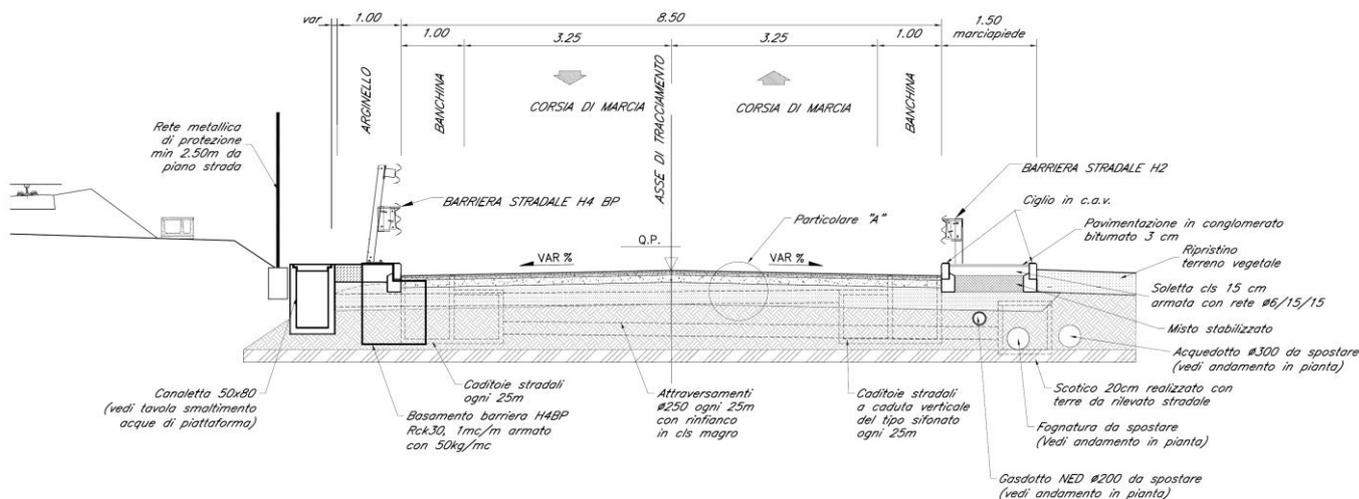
Sezione trasversale tipo di via Magenta nel tratto rilocato
